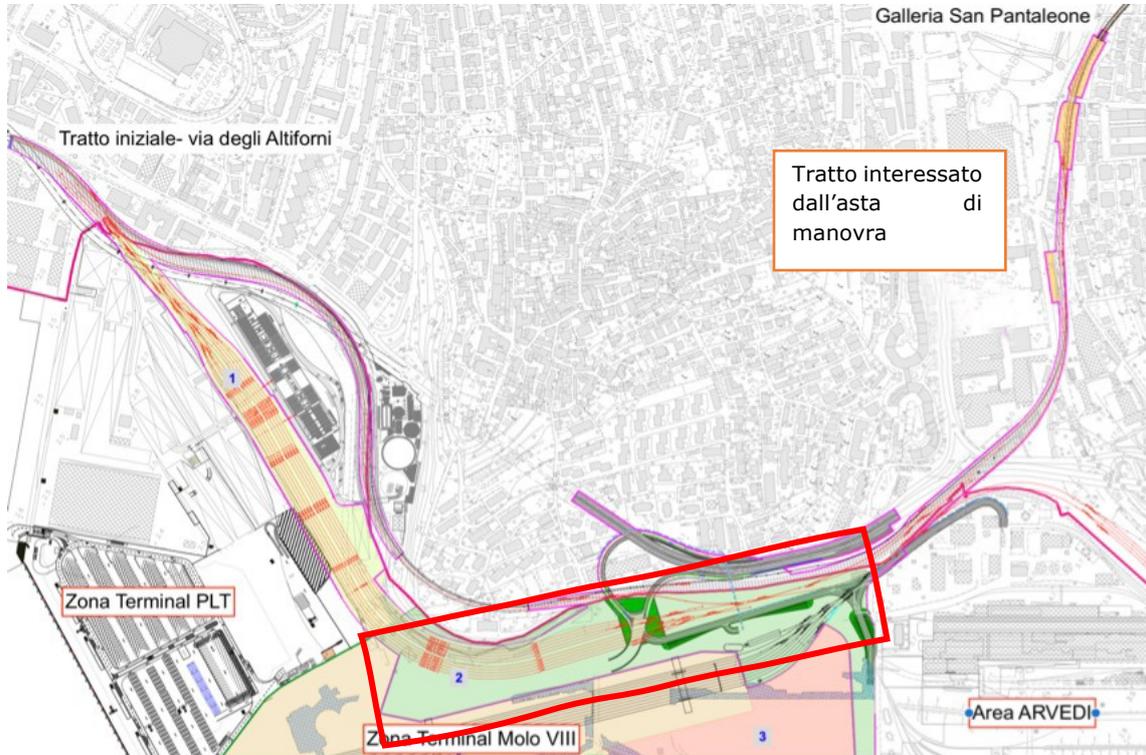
planimetria generale, con evidenziata la Zona Centrale
